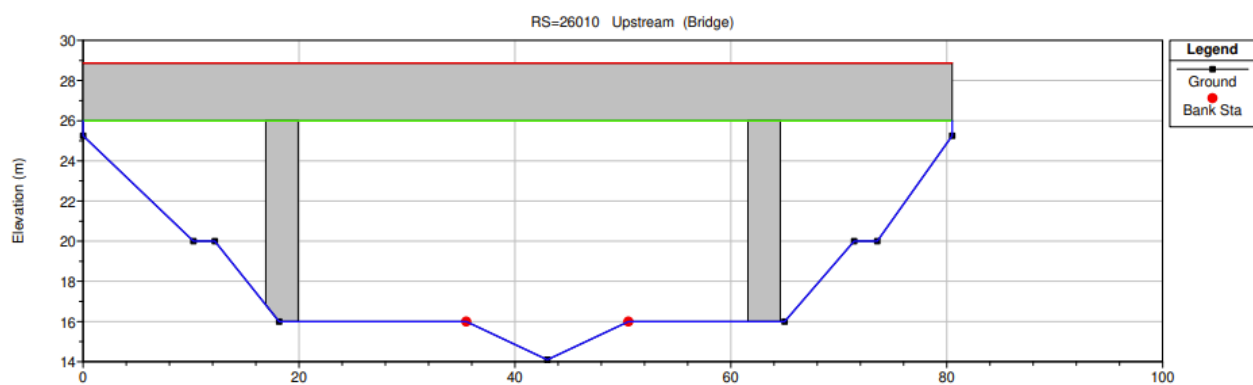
Sezione Hec – Ras del Ponte sul torrente Montone, stato di progetto
